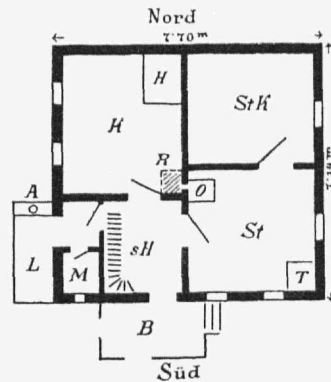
Plan des kleinen Kreuzhauses, Buch 37; erbaut 1808, mit Obergeschoß.
